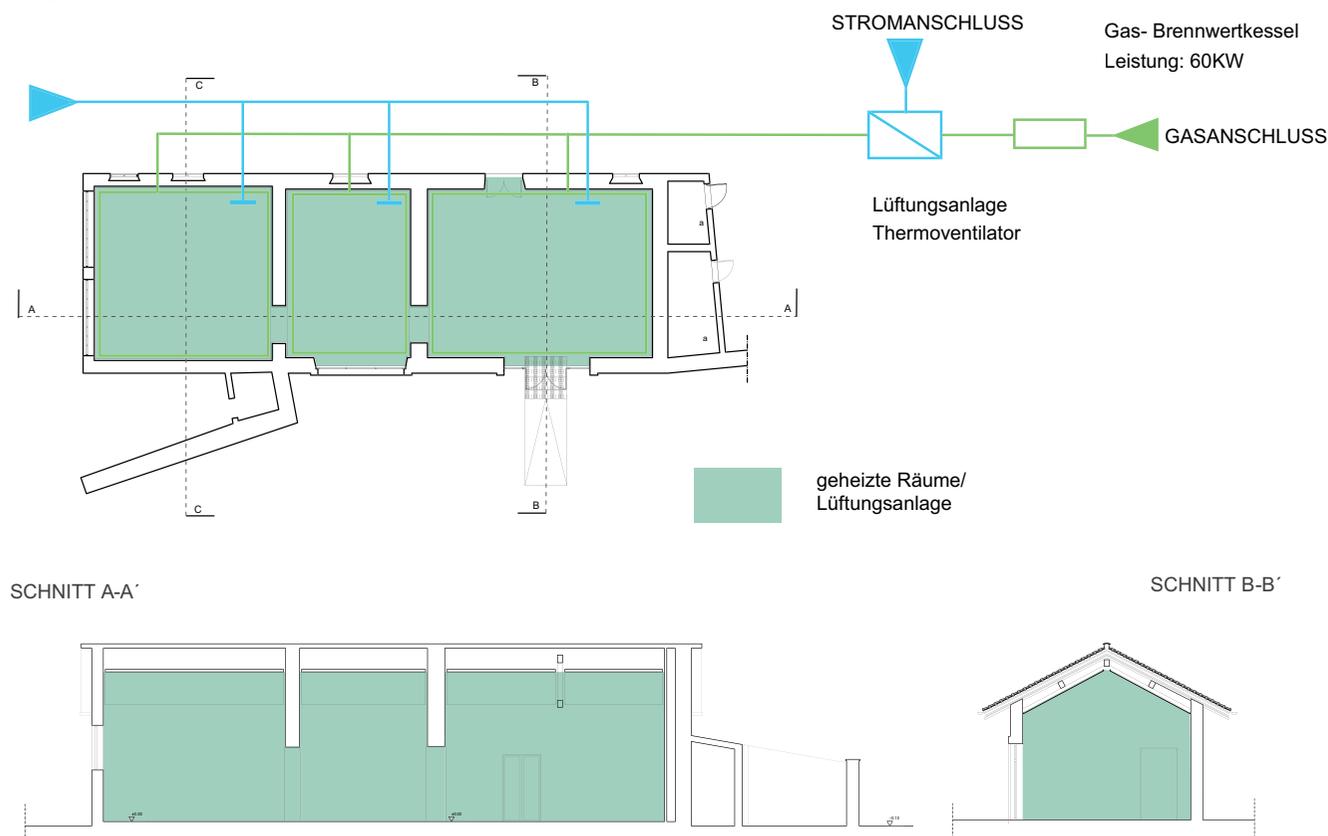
Schema Haustechnik Atelierhaus
